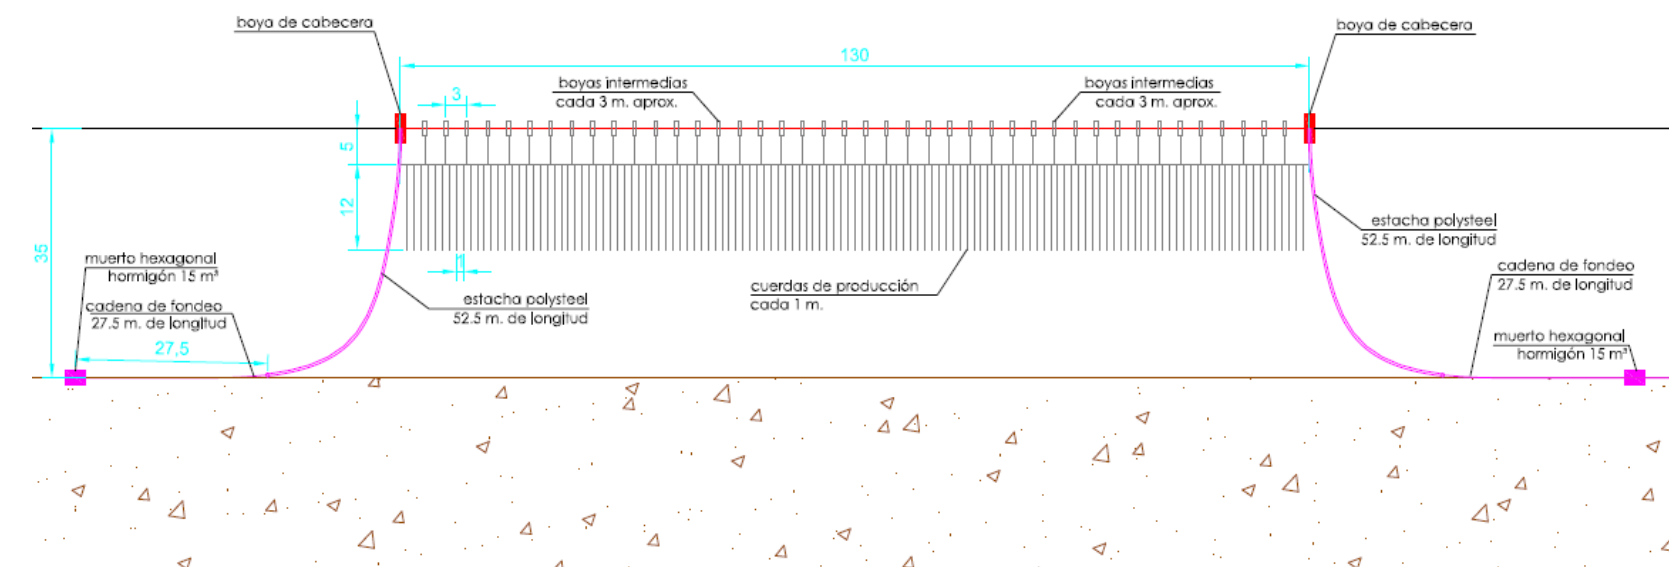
Alzado de Unidad de producción longline situado sobre un fondo de 35 m
